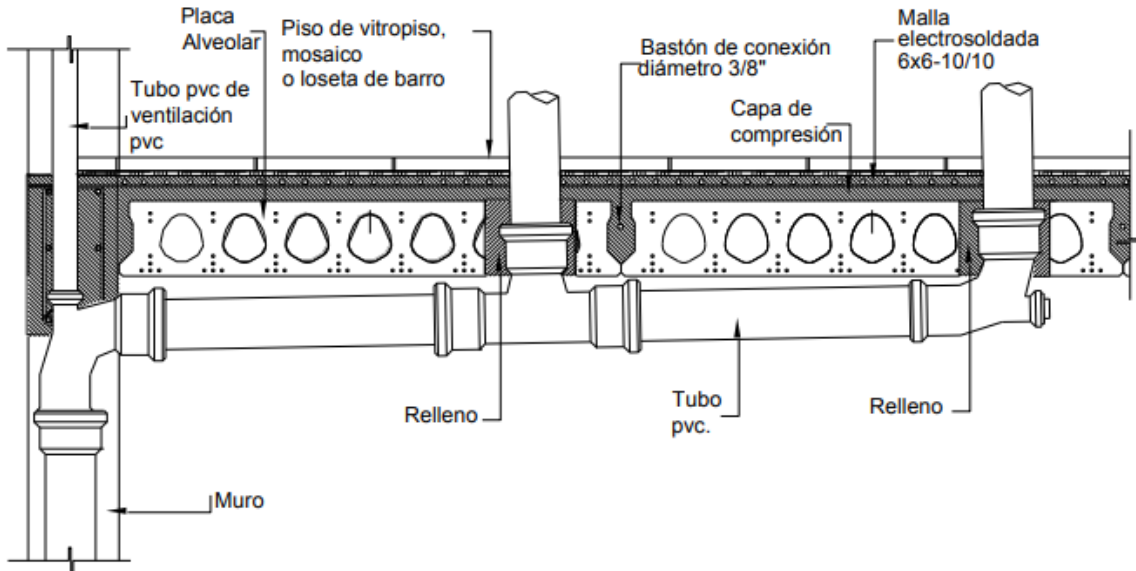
Instalación Hidráulica en Losa Alveolar. (2020).
